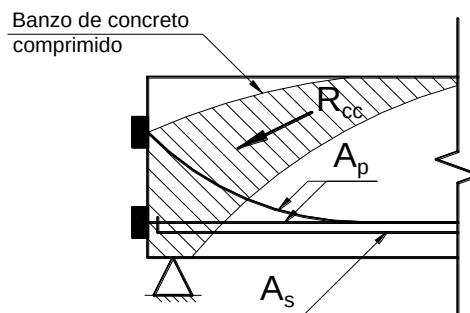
Banzo de concreto comprimido próximo ao apoio.
